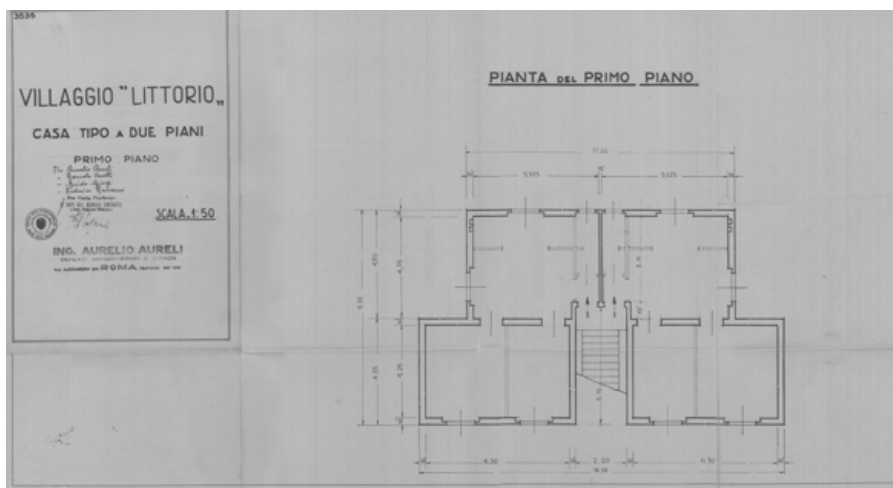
Pianta del primo piano della casa tipo 0 (AQTN)
